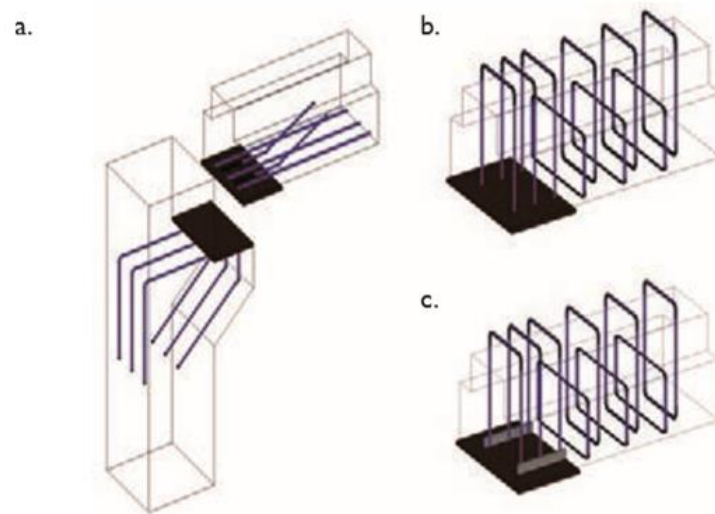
Trasmisión de momentos por soldadura S4 [14]
